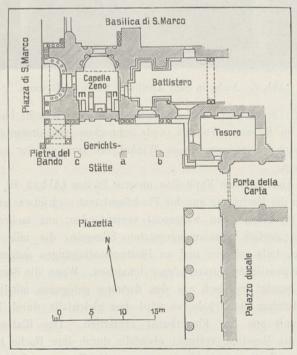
Piazetta in Venedig. Grundriß der nordöstlichen Ecke.
